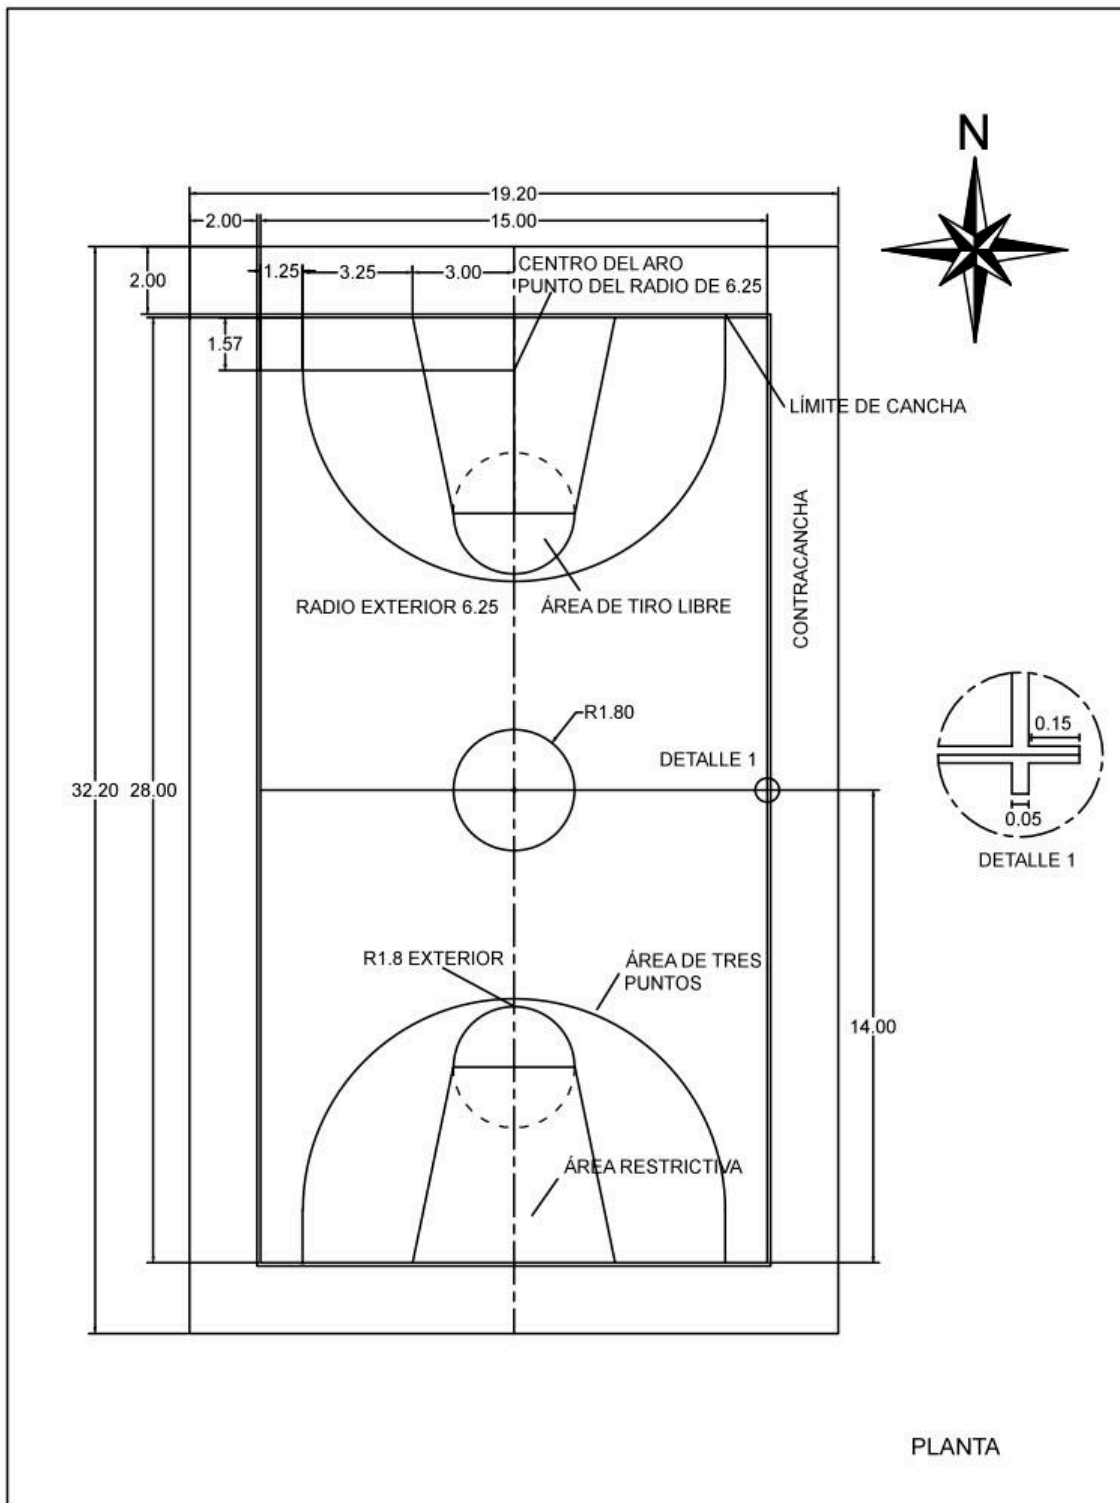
Planta de una cancha de baloncesto. Fuente: Elaboración propia
